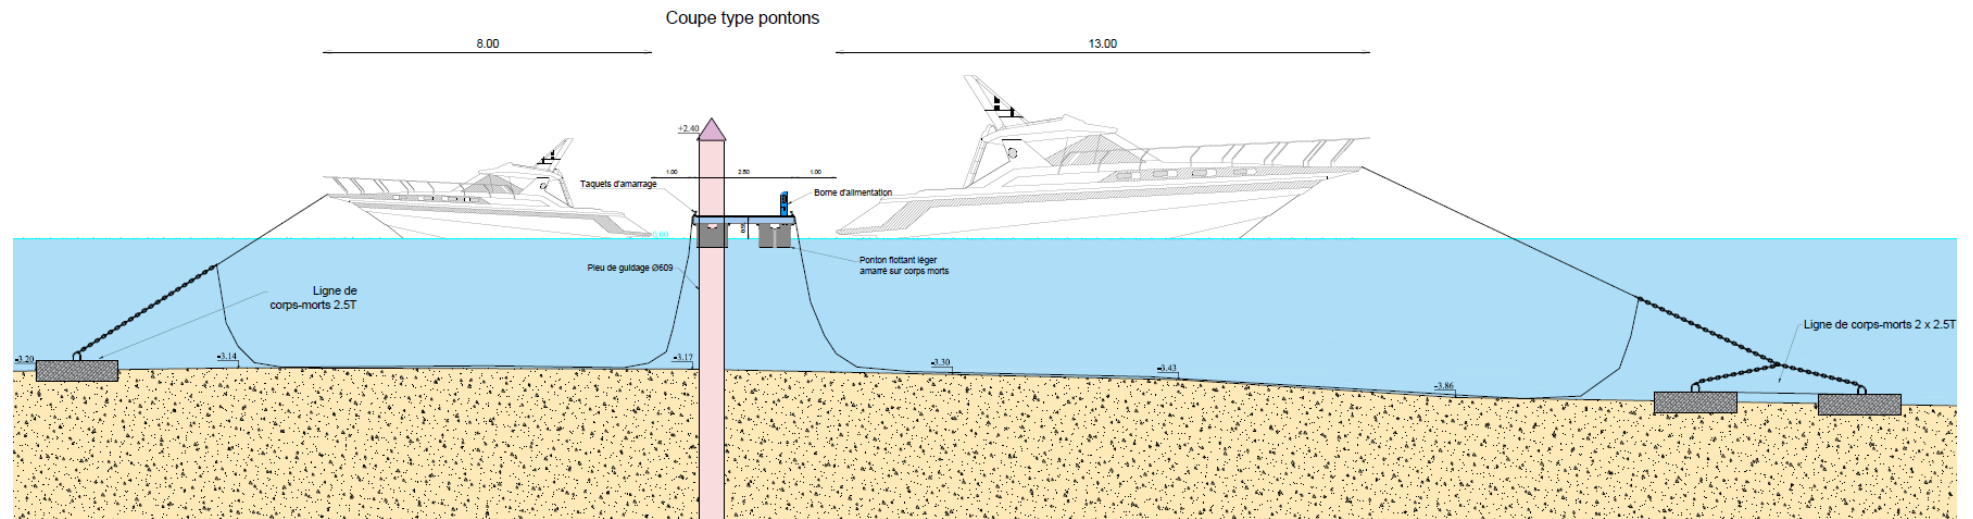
Coupe de principe de ponton flottant sur pieux (SUEZ, 2024)
